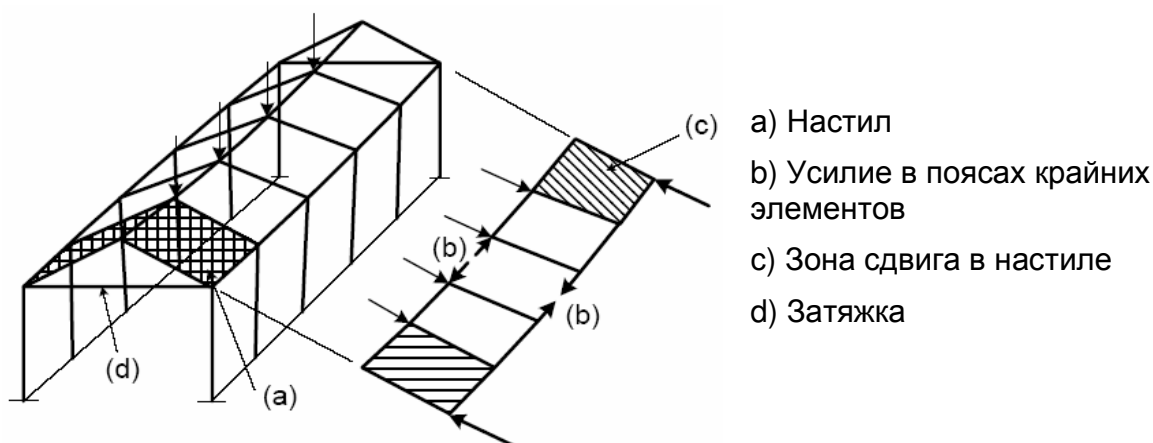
Работа диафрагмы в здании с двухскатной кровлей
